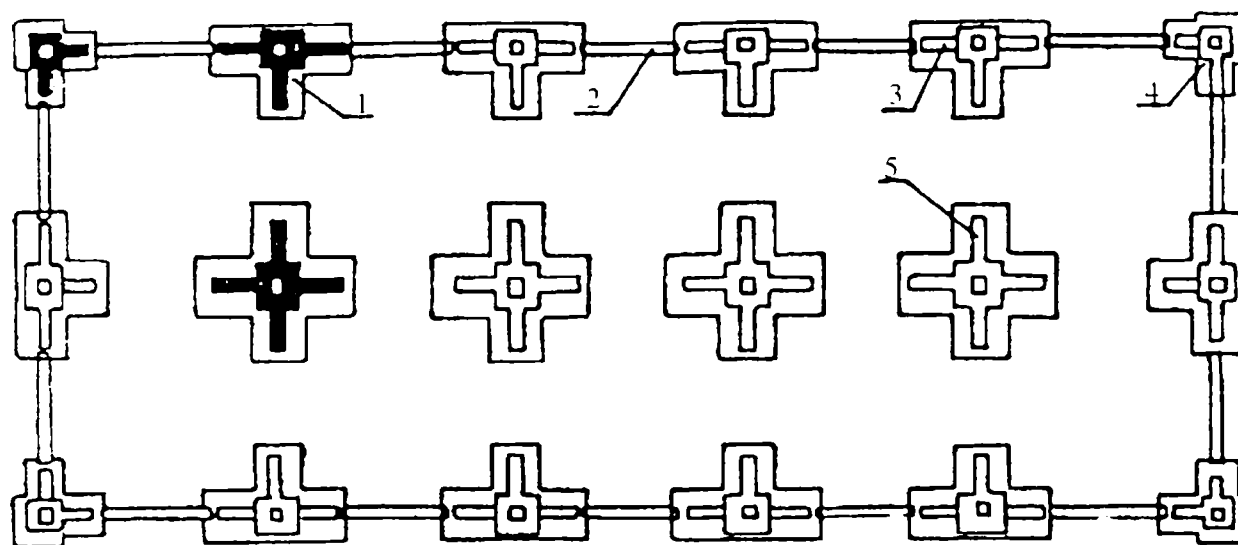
Planul de montaj a elementelor prefabricate: 1 - bloc de fundație din beton simplu; 2 - panou de închidere; 3 - element marginal prefabricat; 4 - element de colț prefabricat; 5 - element central prefabricat.
